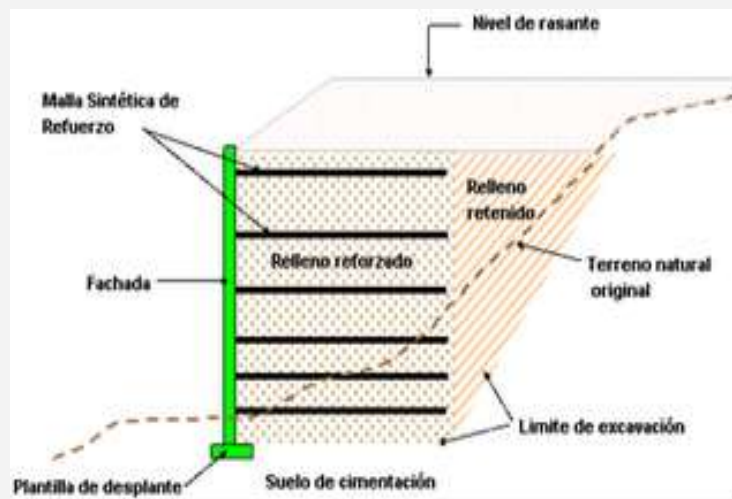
Muro Estabilizado Mecánicamente (MEM)- Elementos Principales
